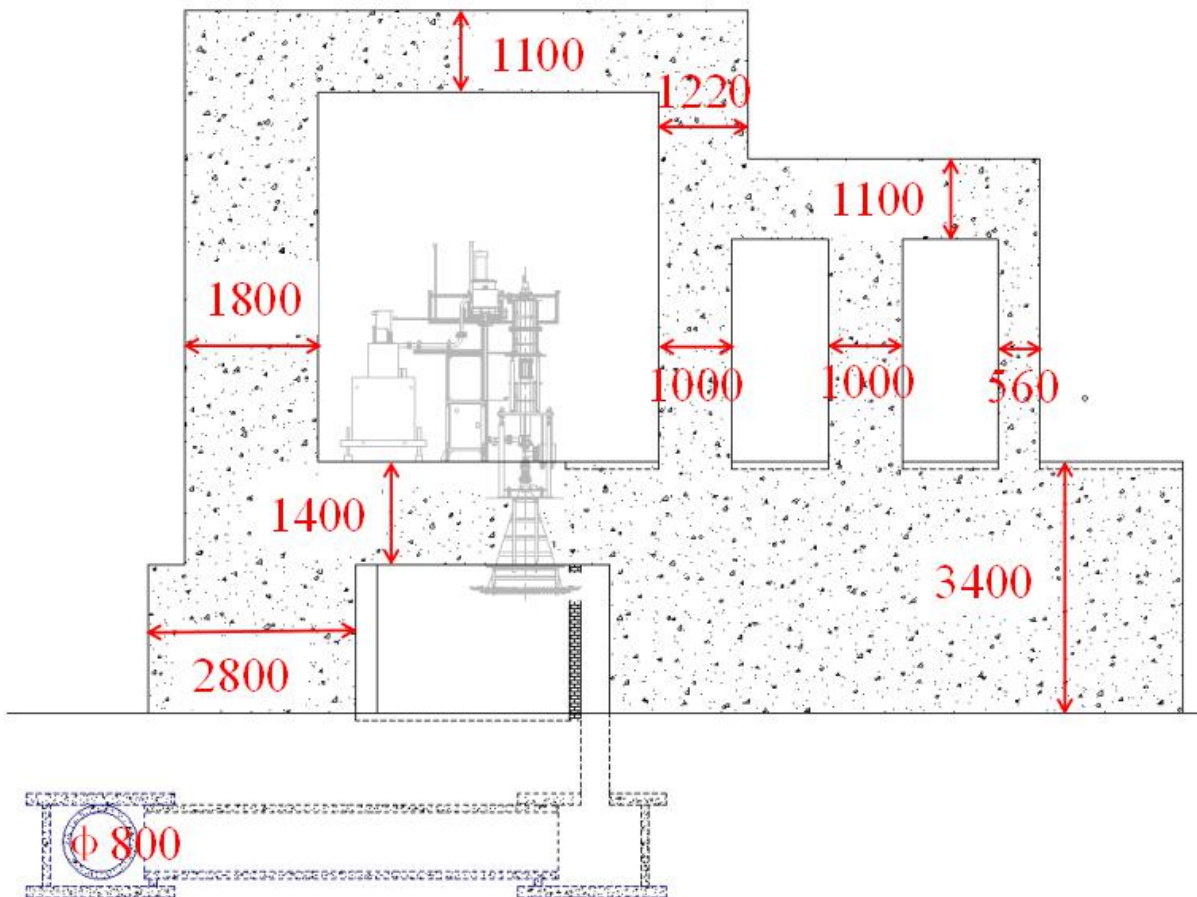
辐照室及主机室墙体屏蔽设计纵剖面图
